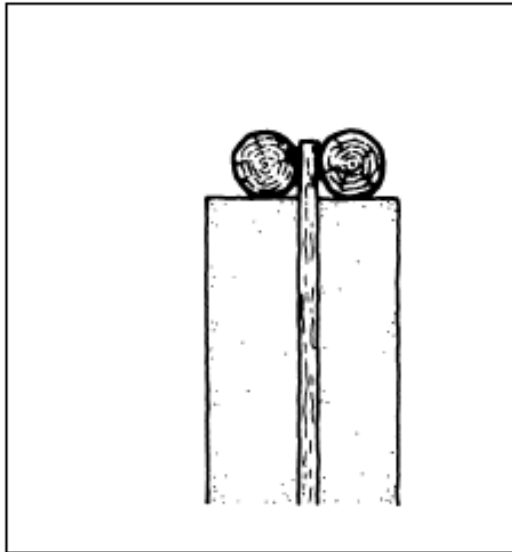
Anclaje del encadenado con los elementos de refuerzo del muro.
